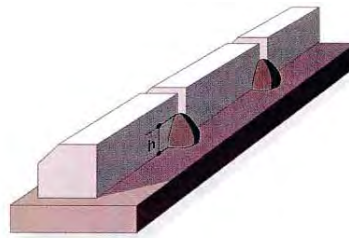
DETALLE DE COLOCACIÓN DE TRAMOS DE GUARNICIONES PREFABRICADAS DE CONCRETO
